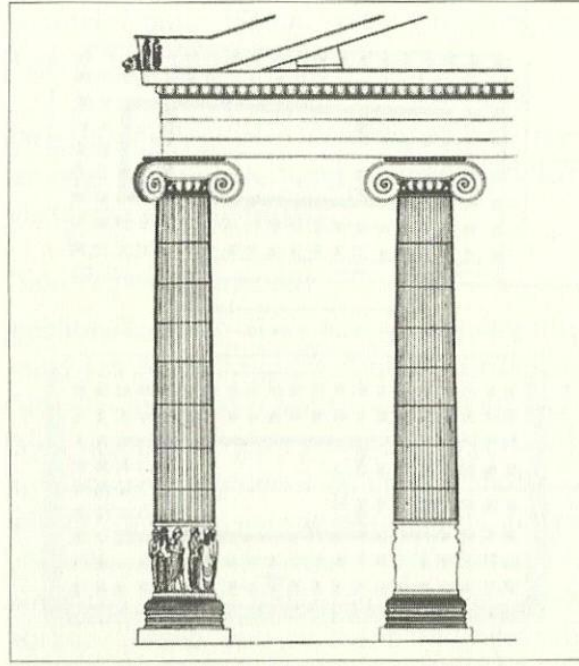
Grek Tapınağında kullanılan türlerin planı (Akdeniz, 2016: 249).
